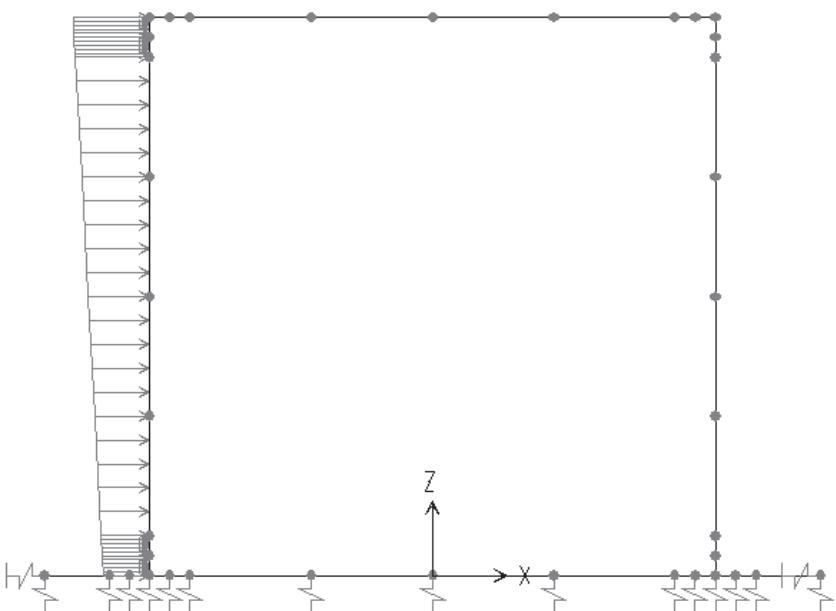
SPINTA DOVUTA DALL’AZIONE VERTICALE DA TRAFFICO SUL PIEDR. DX SQMD
